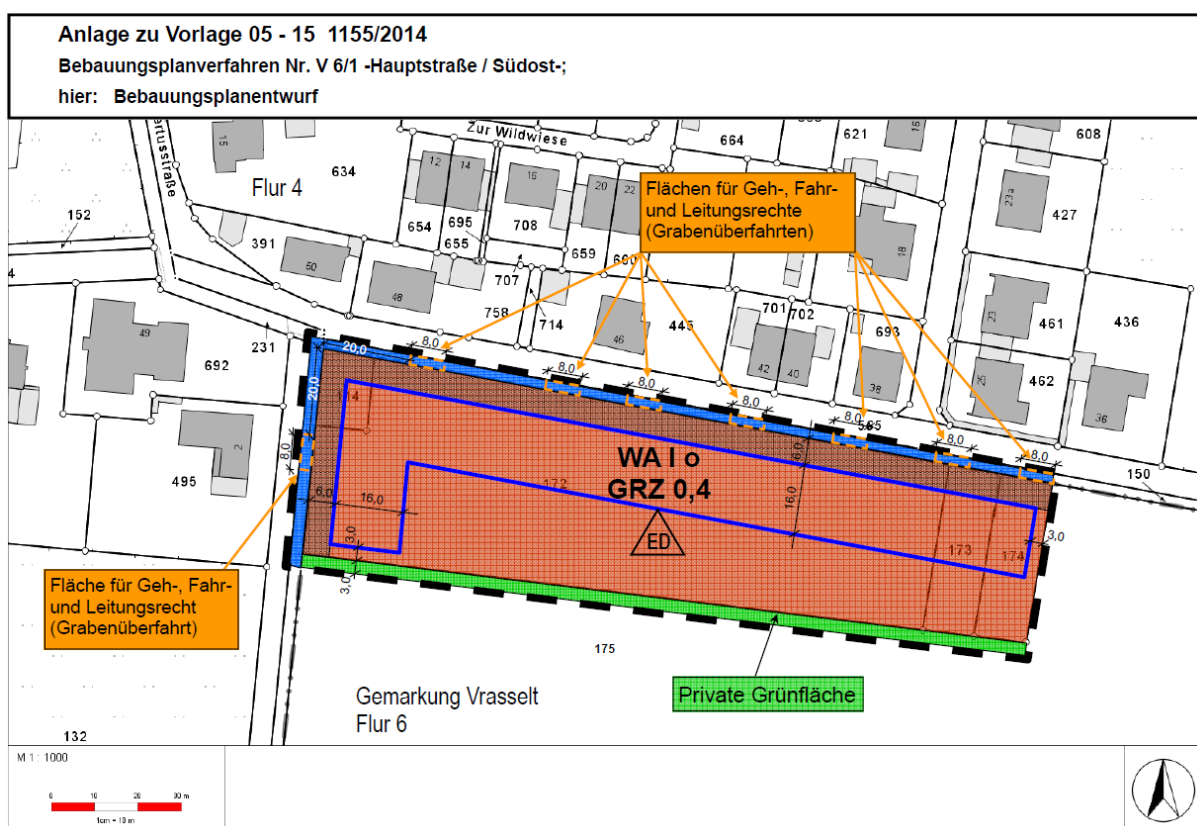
Darstellung des Planbereiches aus der Vorlage zum Bebauungsplan.
